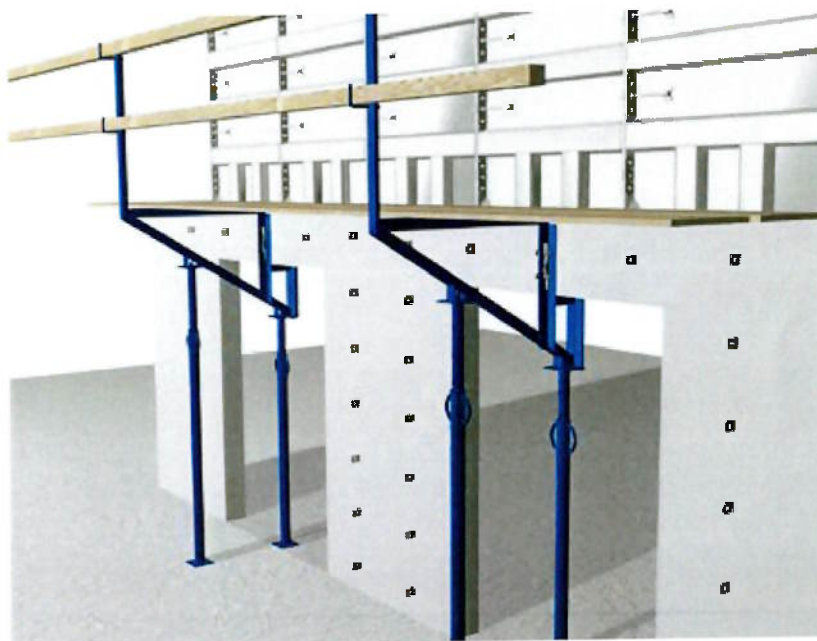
Montagem do suporte com bocal (fonte: catálogo técnico FORSA)
